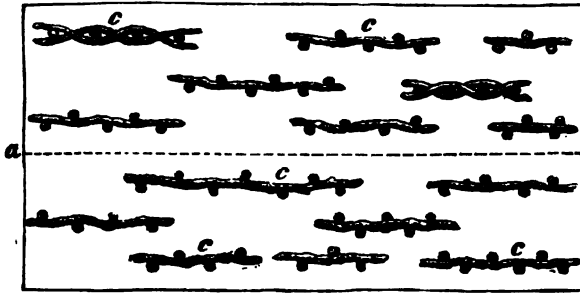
Grundriß einer Lawinenverbauung mit Holz.
